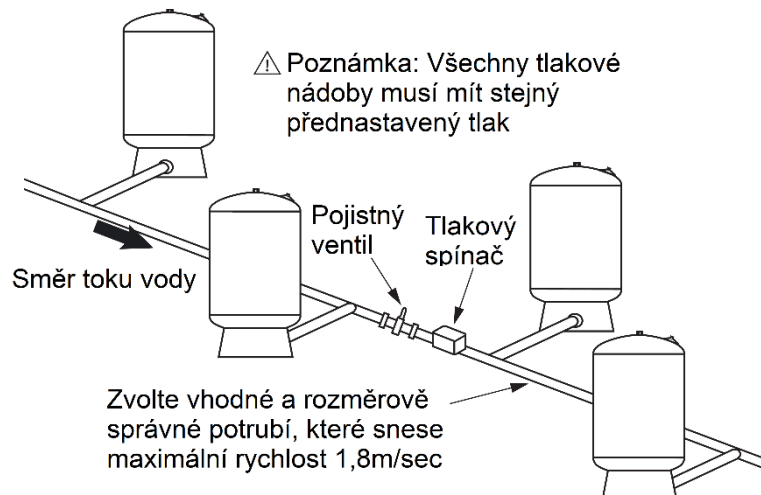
Posilovací stanice s tlakovou nádobou
